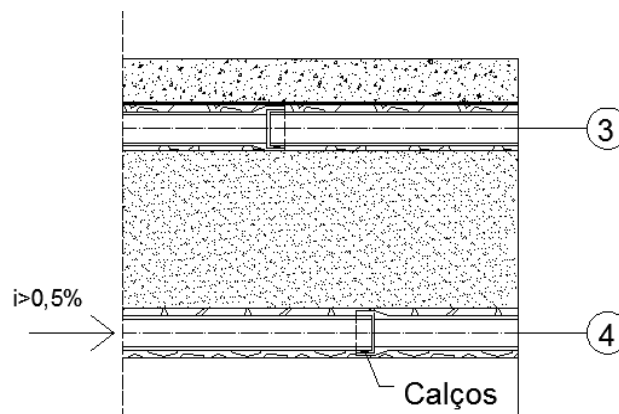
Corte transversal de uma solução de trincheiras de infiltração (adaptada de Bartolomeu, 1996).
